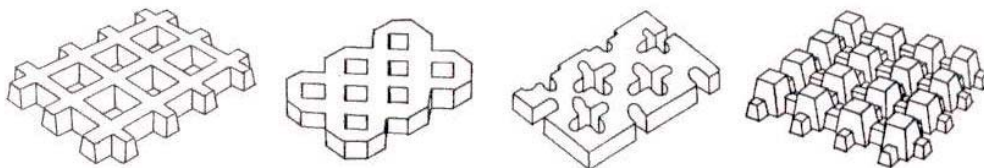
Ejemplos de elementos prefabricados para pavimentos celulares.
